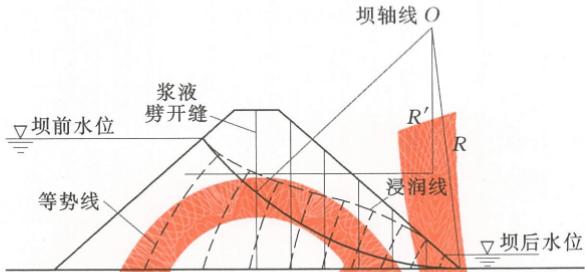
坝体抗滑稳定验算剖面图
